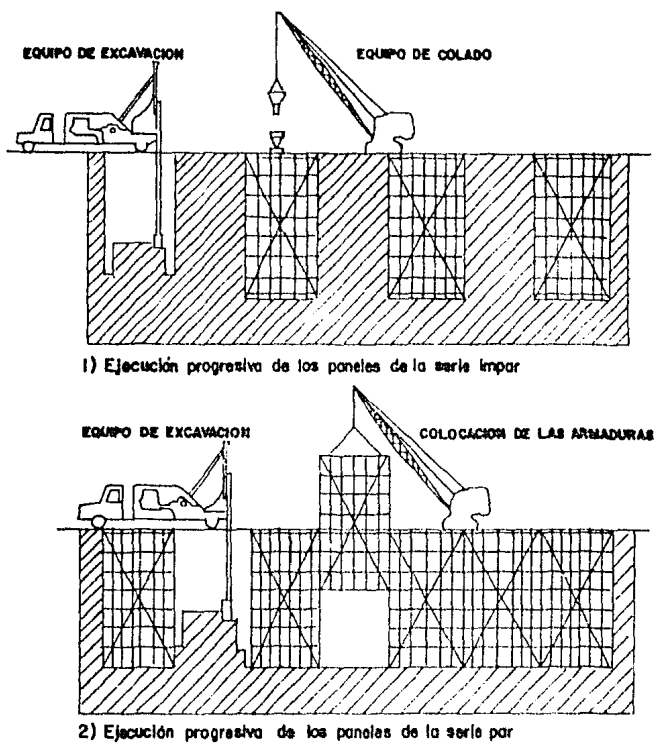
Proceso de ejecución de "Muro colado in situ"
